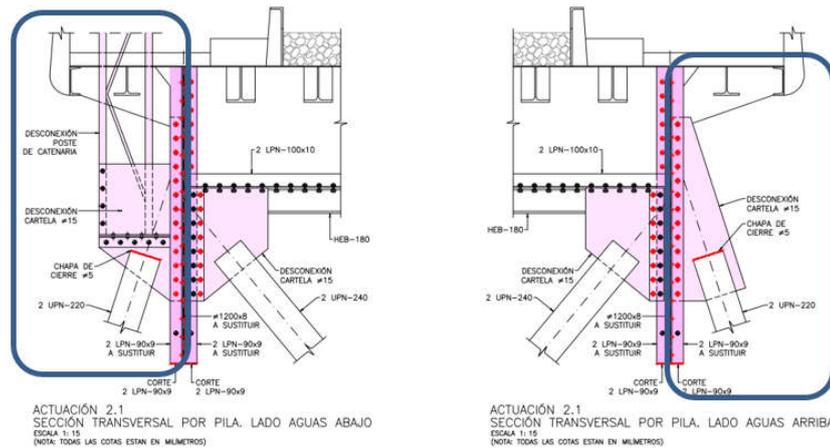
Nudo superior mamparo de pila. Desatornillado de contraviento
